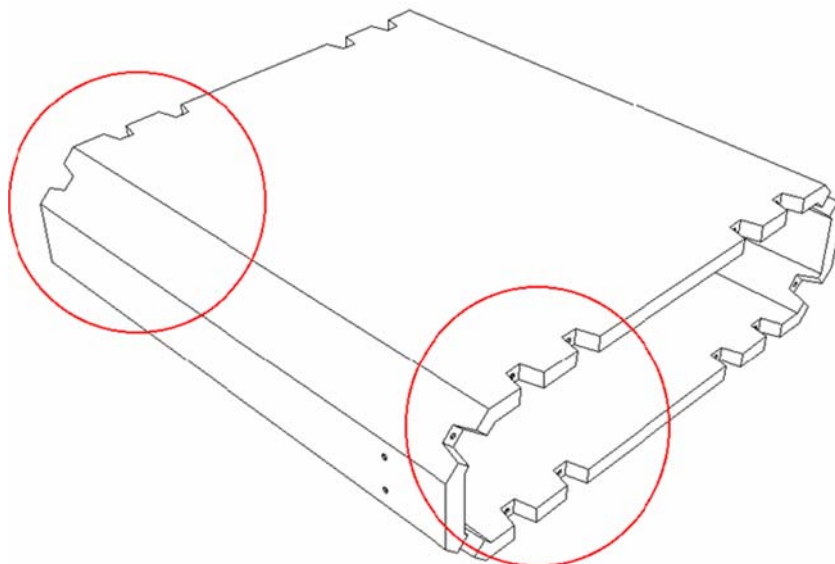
Nicho de protensão deixado no instante da moldagem dos elementos pré-moldados.
